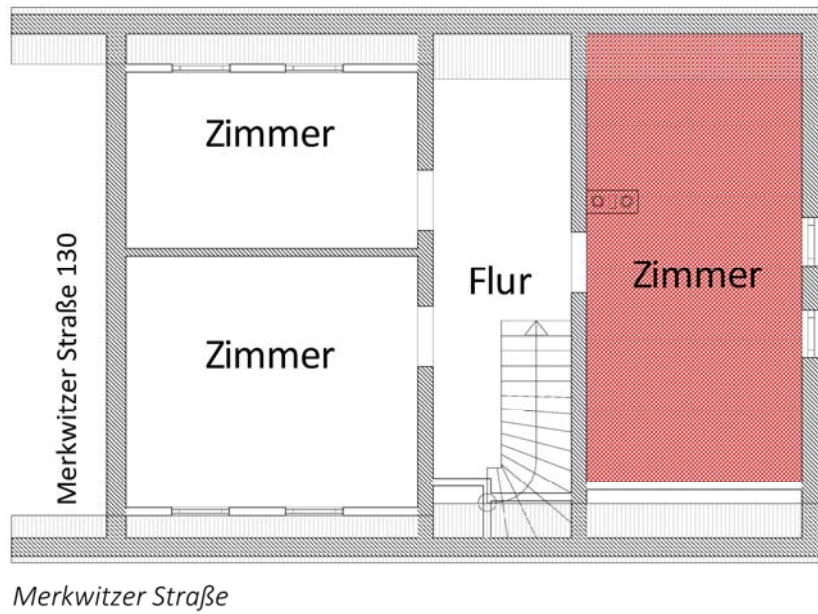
Gebäudeansicht, Detail Dachgeschoss
